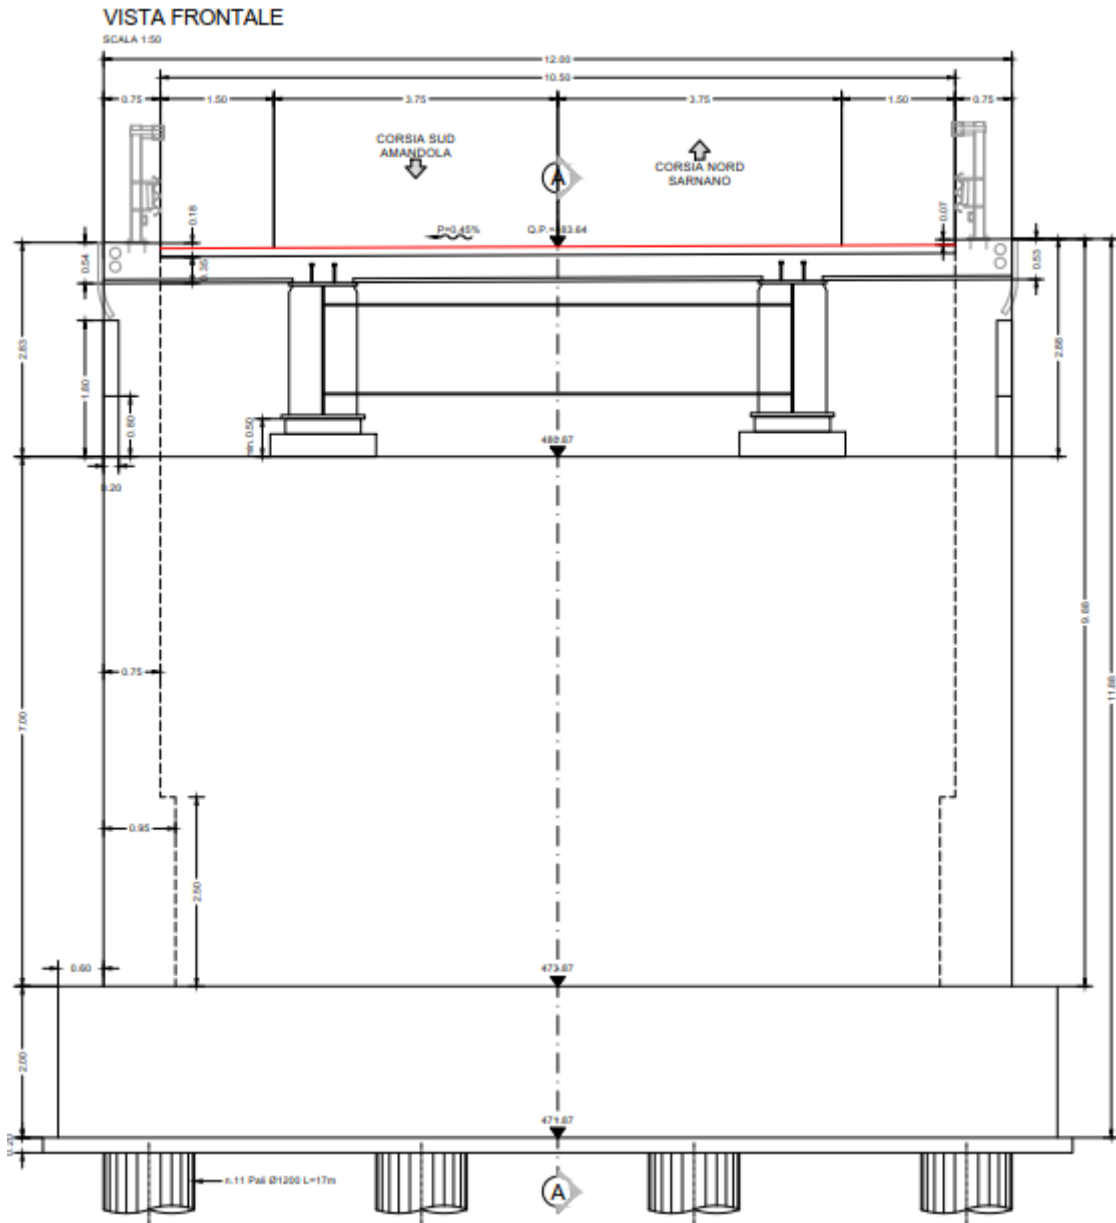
Vista frontale spalla A lato Sarnano
